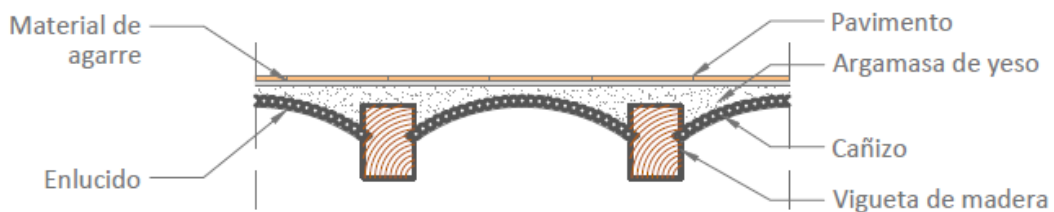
Forjado formado por viguetas de madera y revoltón de yeso con cañizo. Elaboración propia
